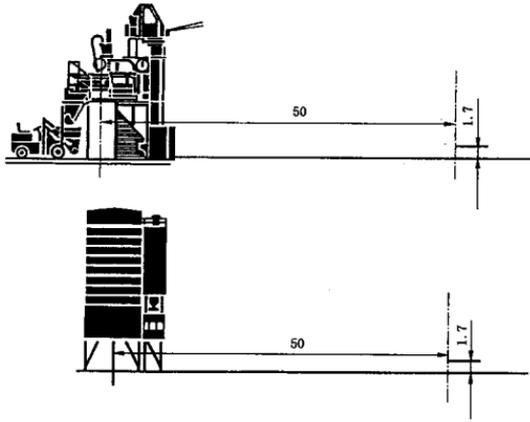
混凝土搅拌站(楼)的粉尘测试位置示意图
